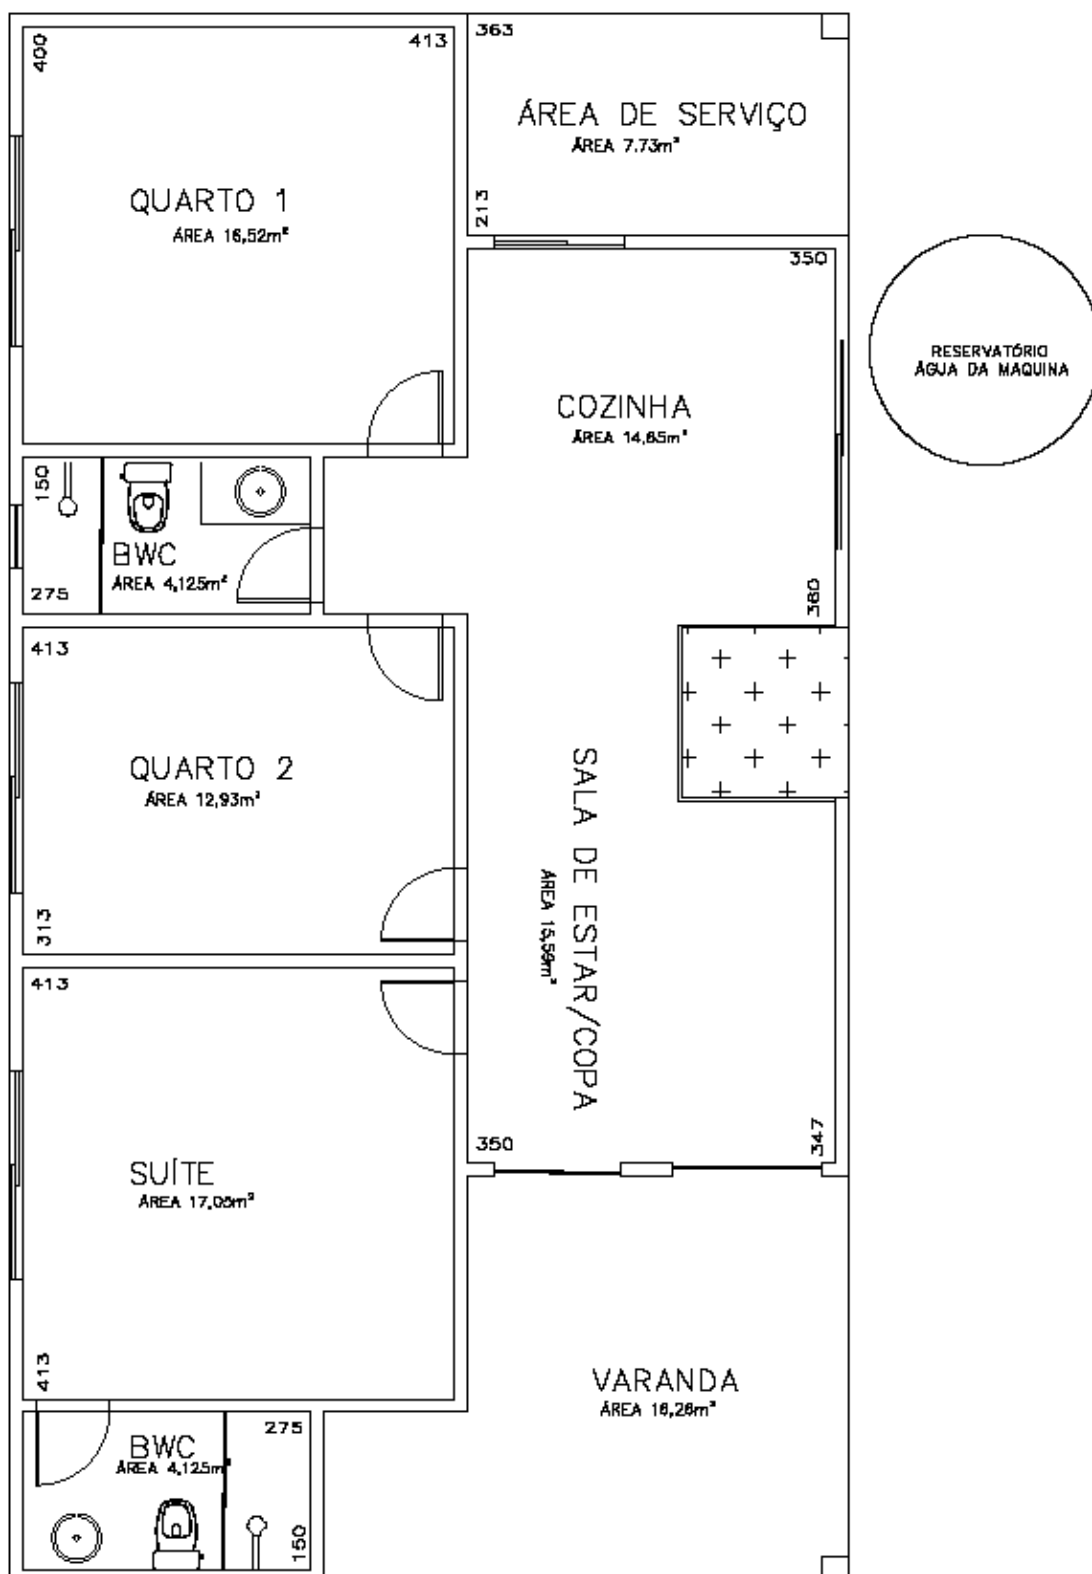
Planta baixa casa convencional com técnicas sustentáveis
